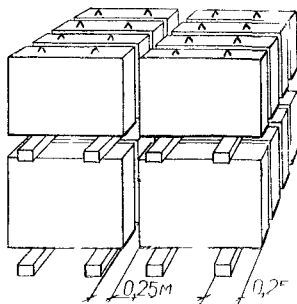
Бетонные блоки укладывают в два ряда на подкладках и прокладках.
